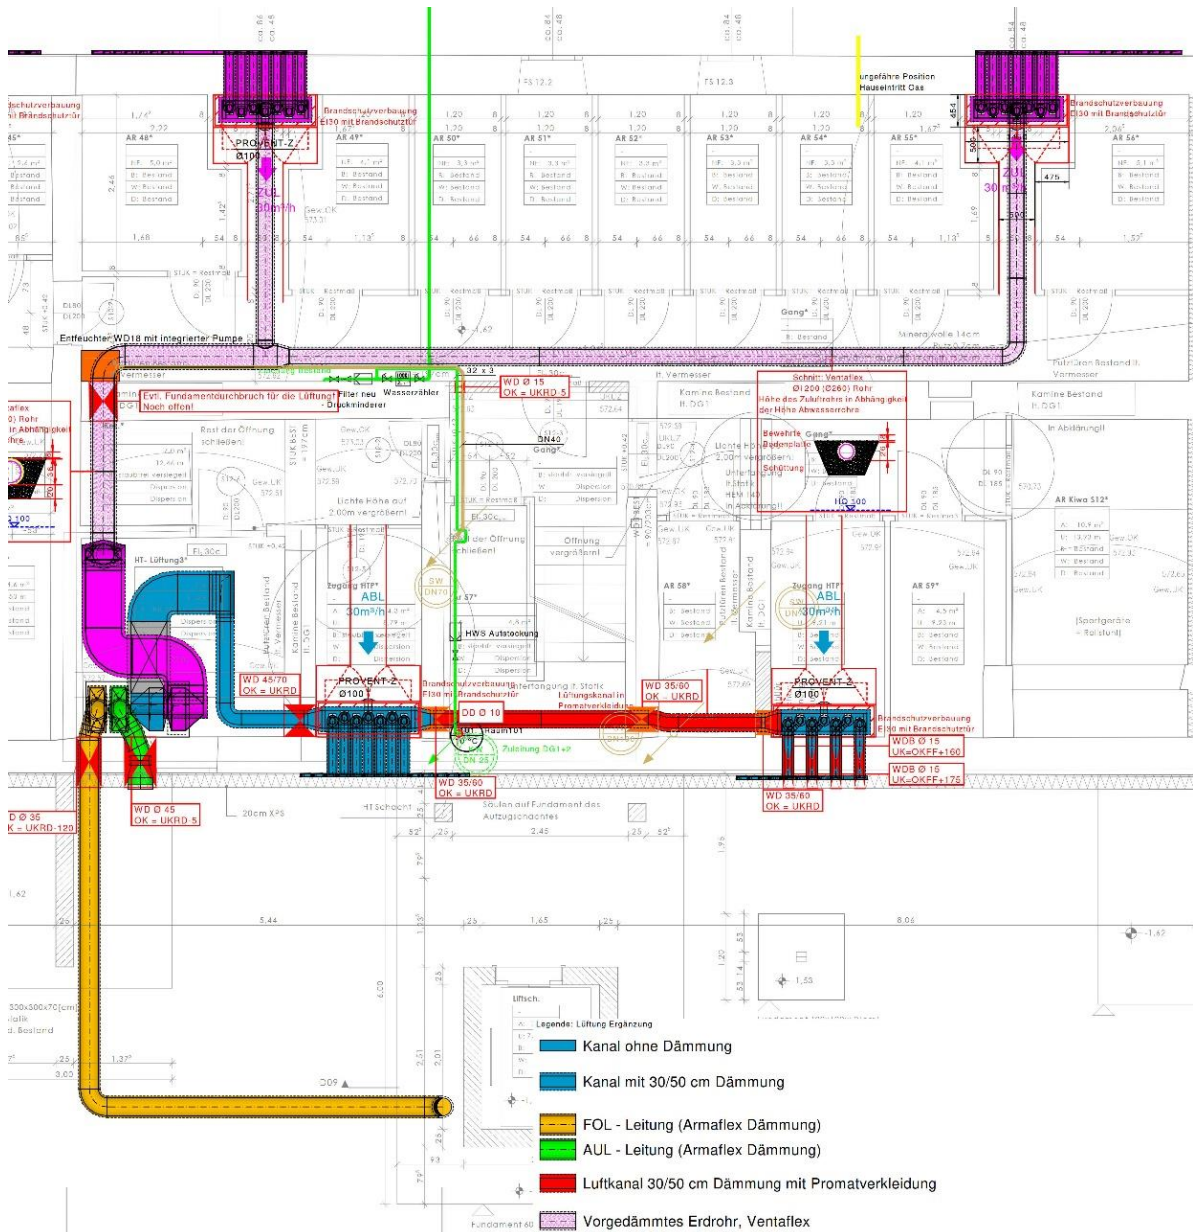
Grundriss Kellergeschoß; Quelle: Alpsolar Klimadesign
